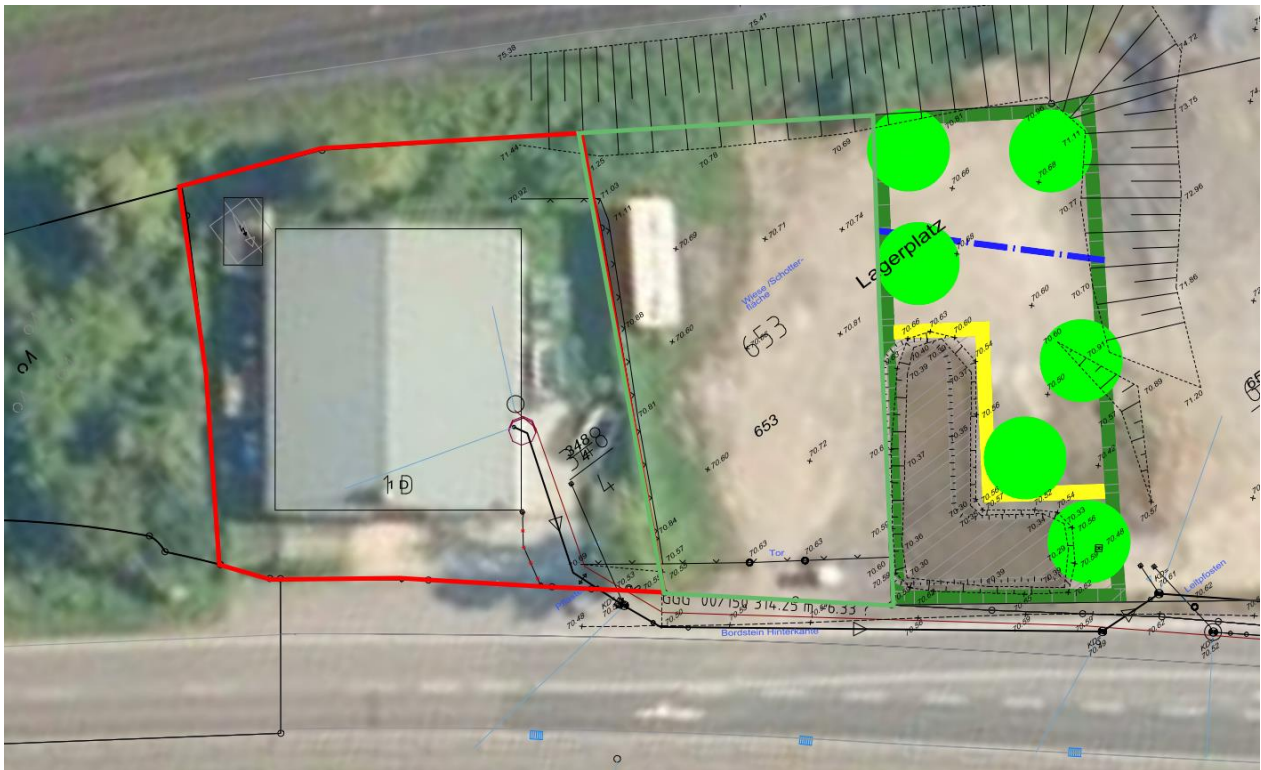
Lageplanausschnitt – Bestandsfläche mit Betriebshalle (rot), Erweiterungsfläche (grün) und B-Plan
